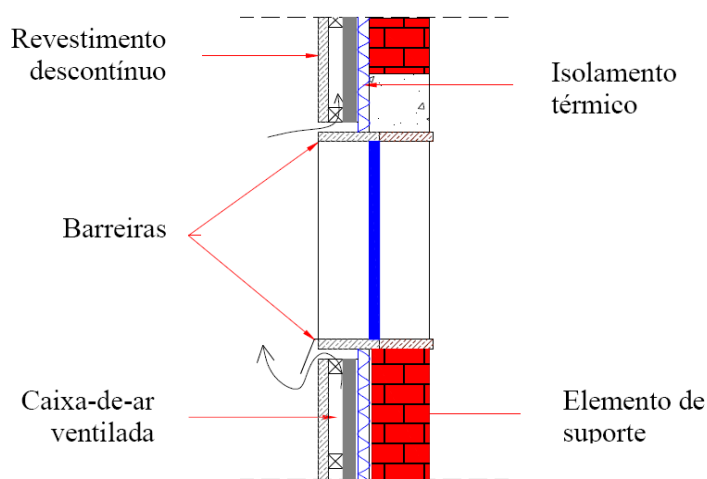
Barreiras contra a propagação vertical do fogo [3]
